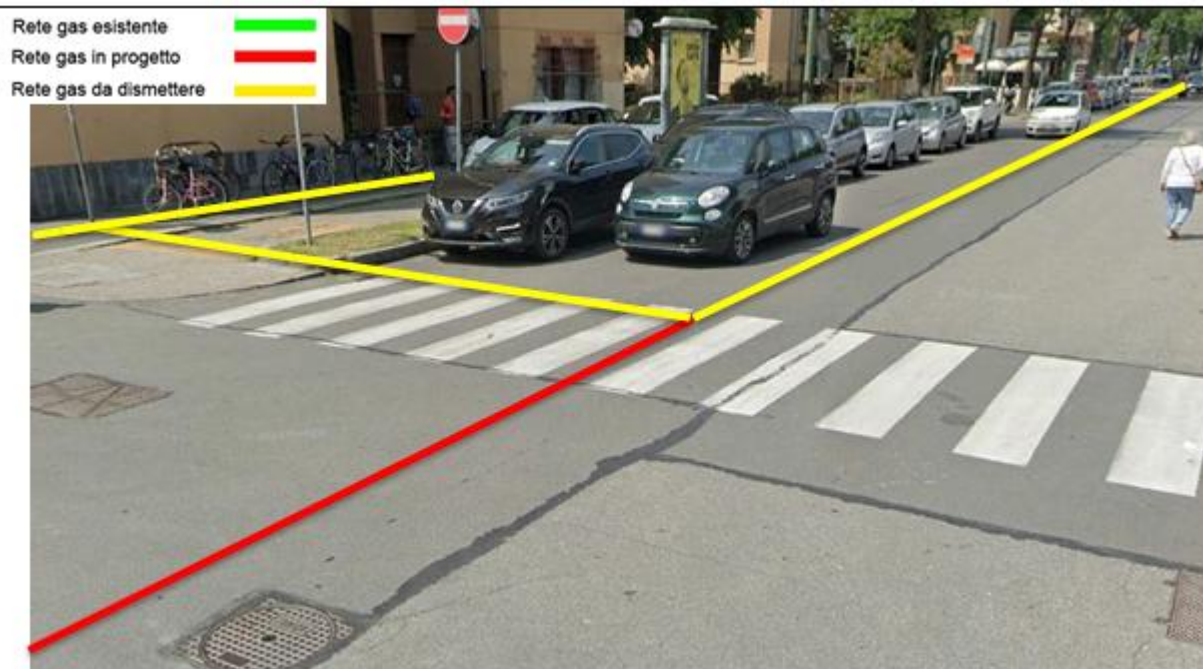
Stacco condotta Via Giulio Biglieri direzione Via G. Zuretti
